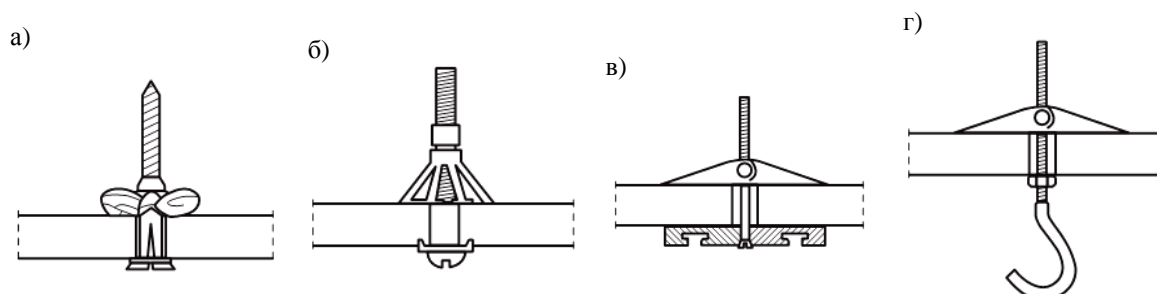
Схемы крючков и специальных дюбелей для крепления навесного оборудования на подвесной потолок
